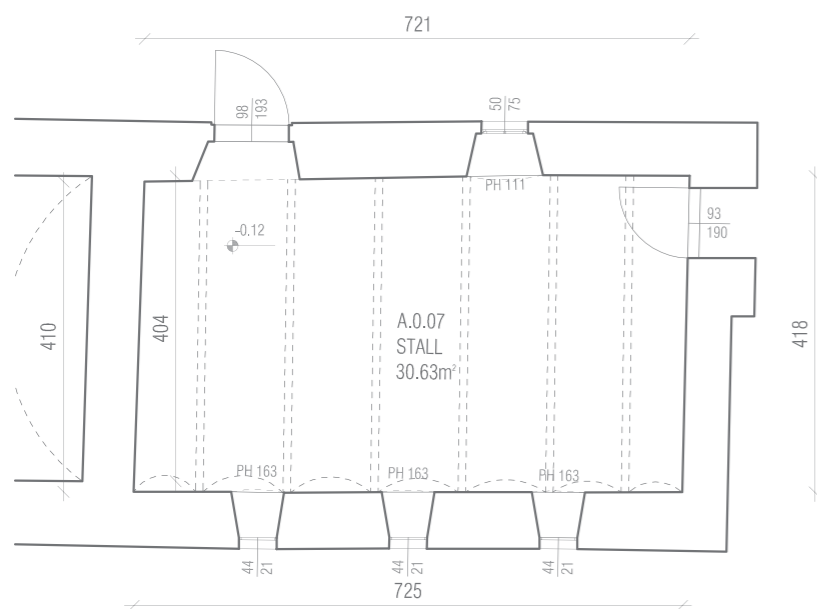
Grundriss Raum A.0.07_1:100
